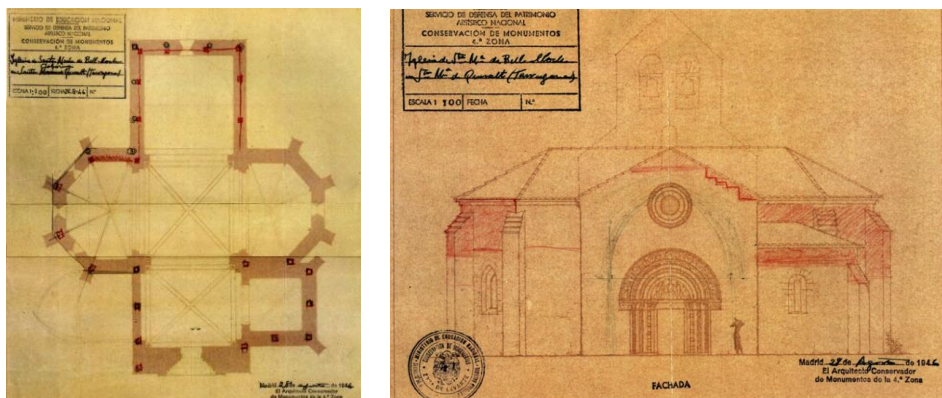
Santa Coloma de Queralt. Iglesia de Santa María de Bell-Lloch AAFV. Planos de Proyecto. Planta y Alzado. Ferrant. 1946
